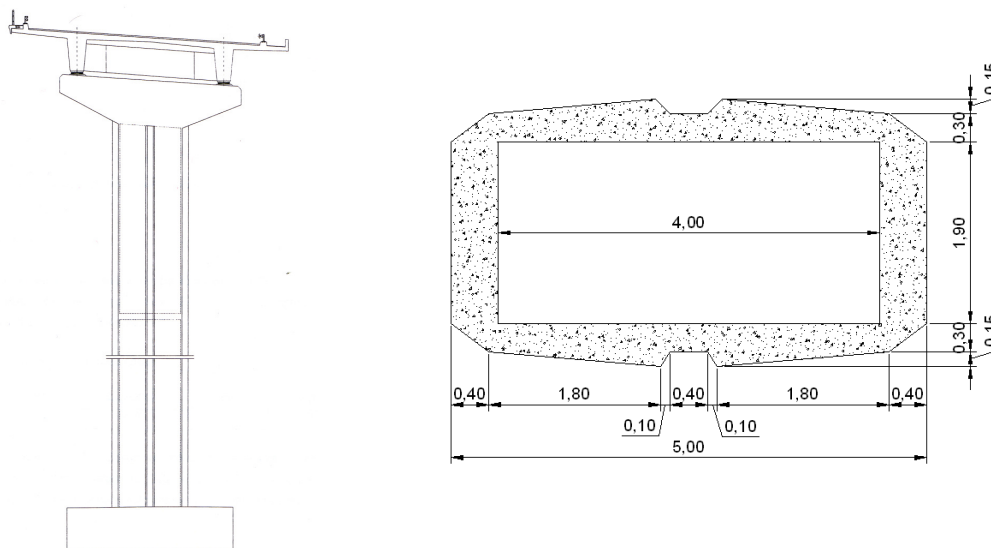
Alçado do pilar, corte transversal do tabuleiro e geometria da secção transversal dos pilares.
